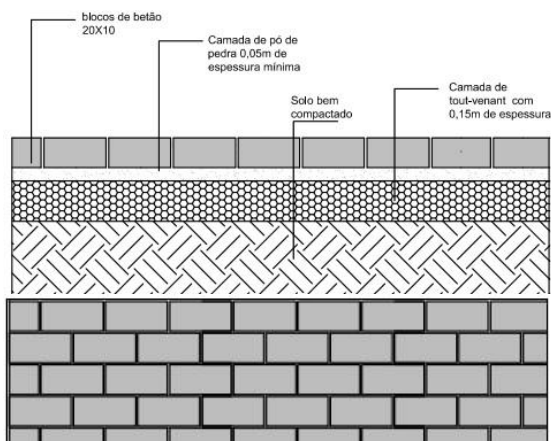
Proposta: Pormenores Construtivos, pavimento rodoviário, pavê cinza. Fonte: Autor; Autocad pelo Autor, (Anexo 5)
